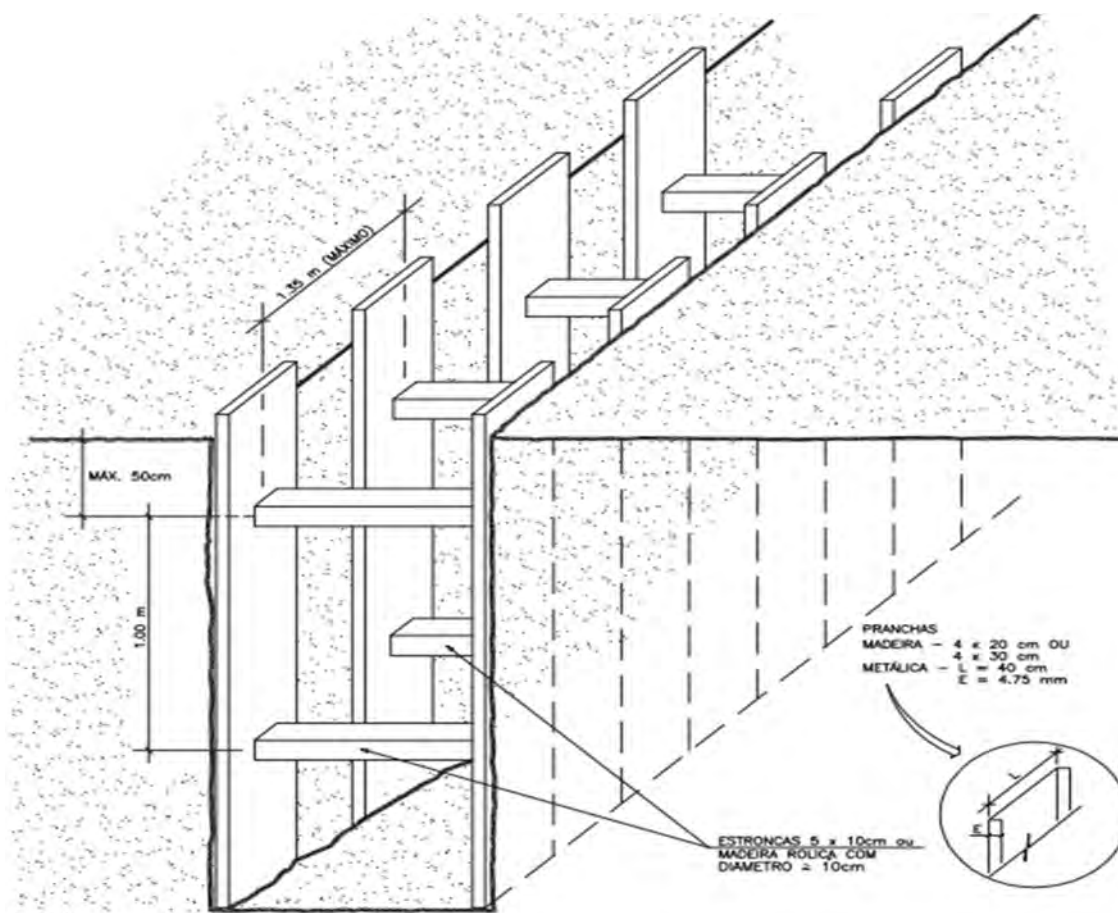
Detalhe de escoramento tipo Pontalete Metálico
